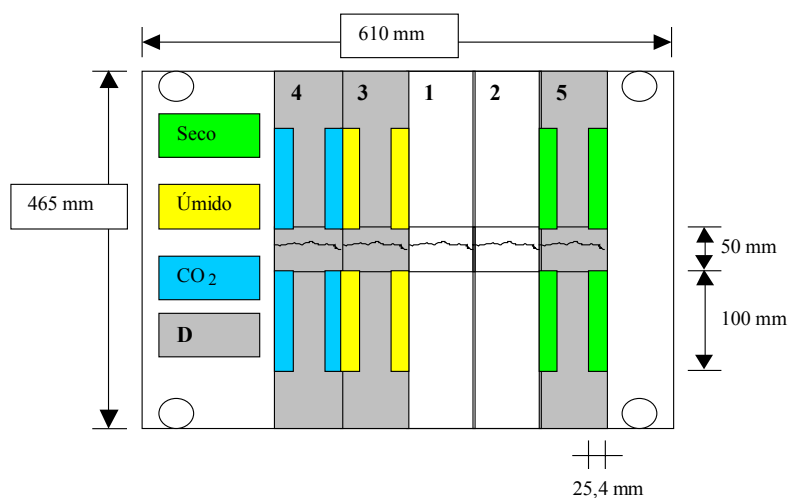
Extração de corpos-de-prova para ensaio de compressão paralela a superfície.
